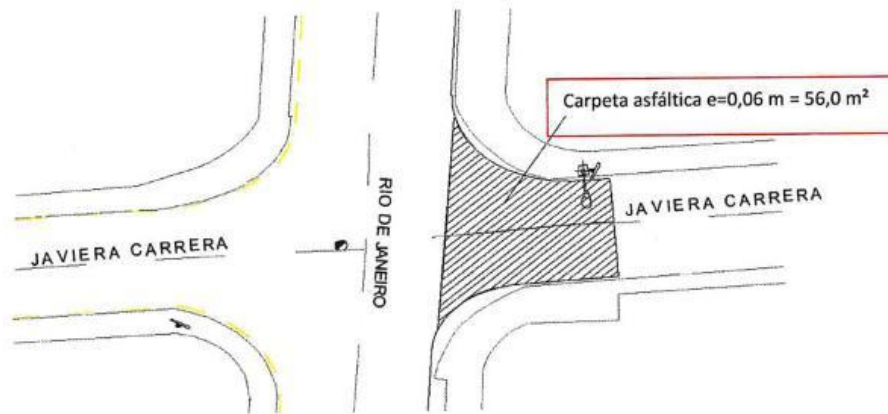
Reposición de calzada asfáltica en calle Javier Carrera con calle Río de Janeiro, lado oriente.
